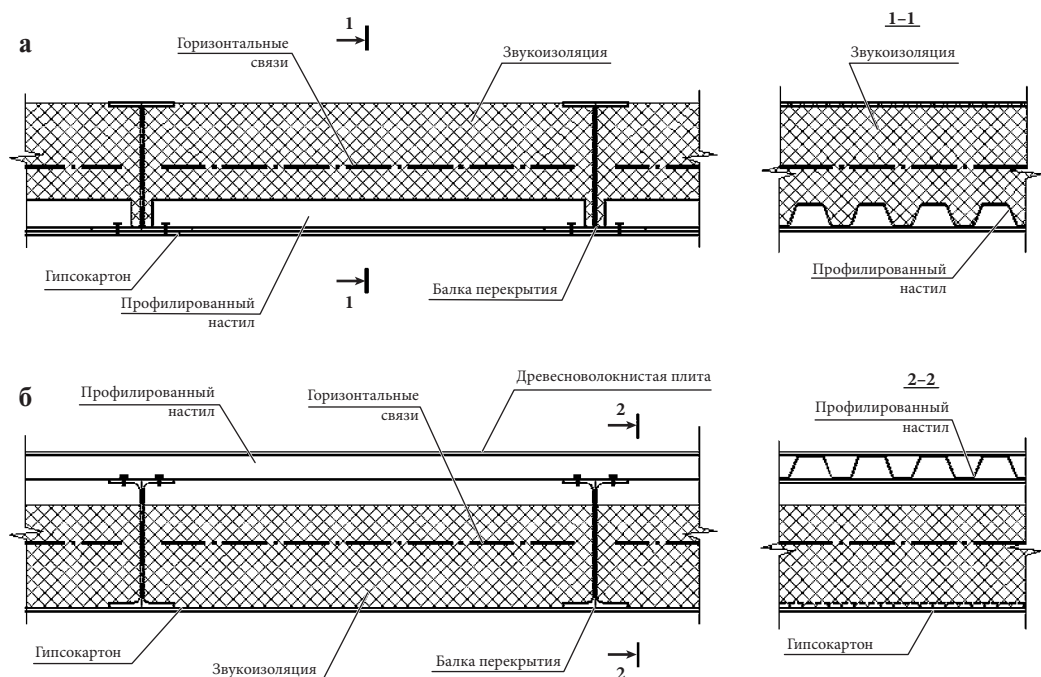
Перекрытия многоэтажных зданий с использованием профнастила с опирание профнастила: а) на нижнюю полку; б) на верхнюю полку
